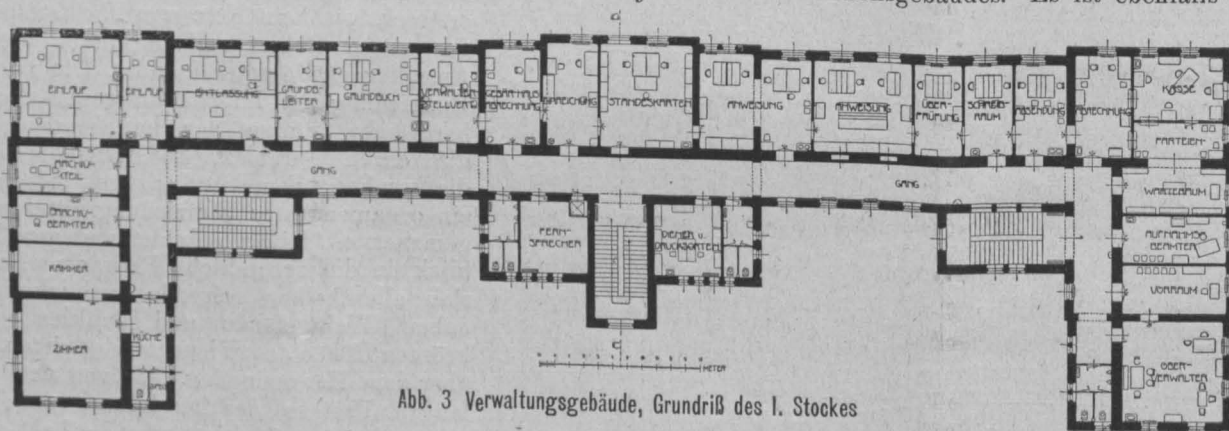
Verwaltungsgebäude, Grundriß des I. Stockes
